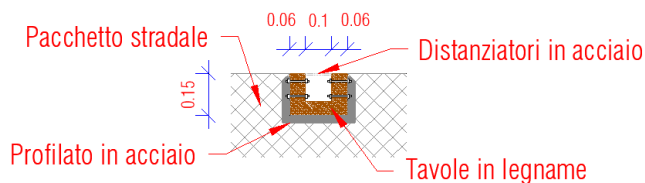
Estratto dalla tavola di progetto - Canaletta trasversale.
